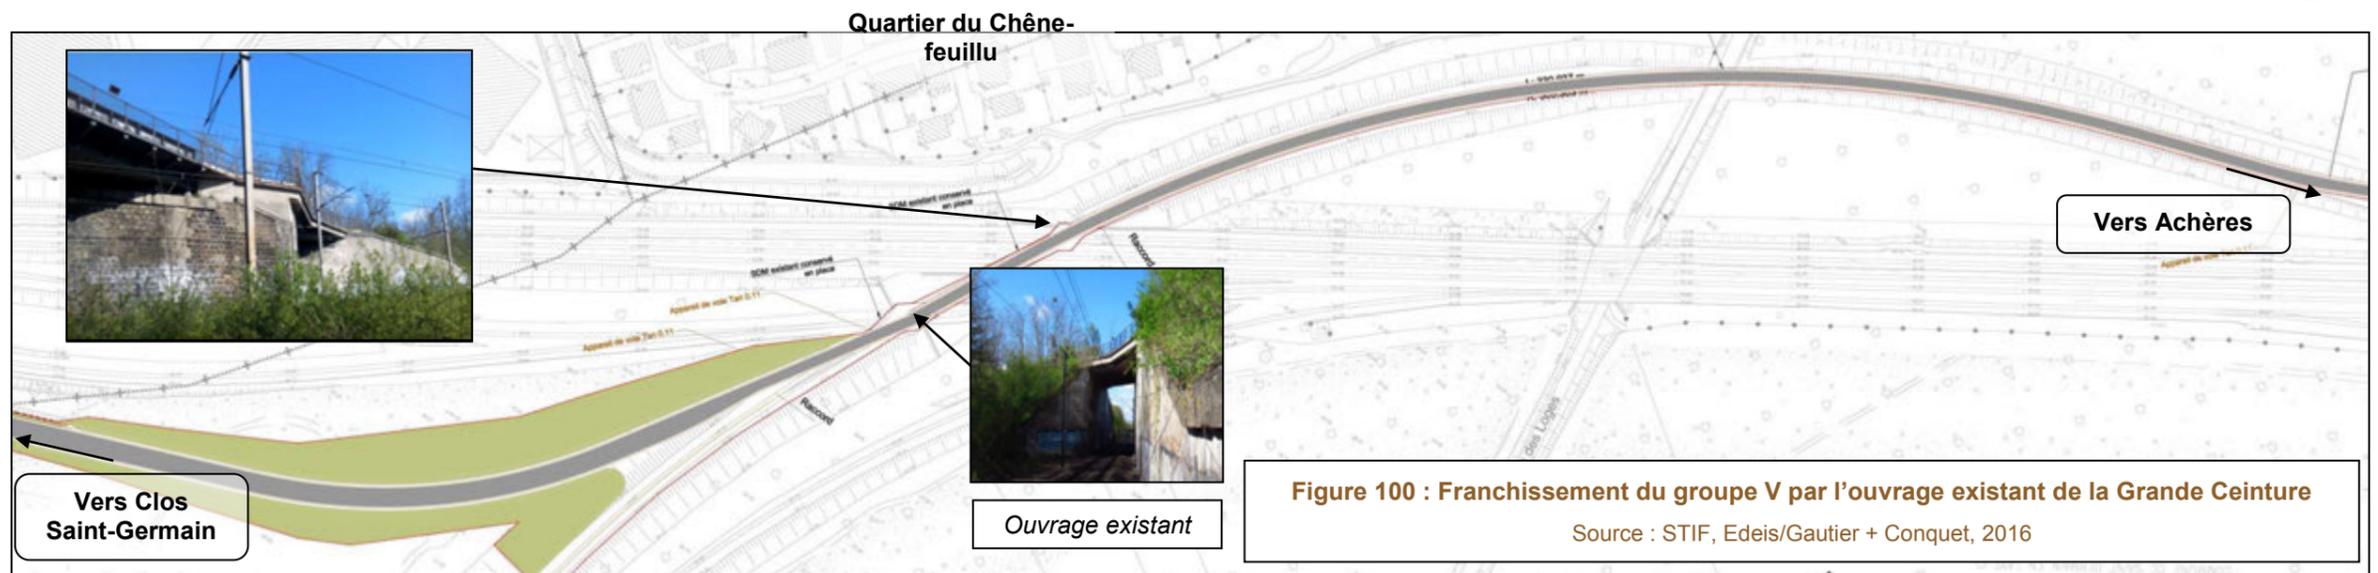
Franchissement du groupe V par l'ouvrage existant de la Grande Ceinture
